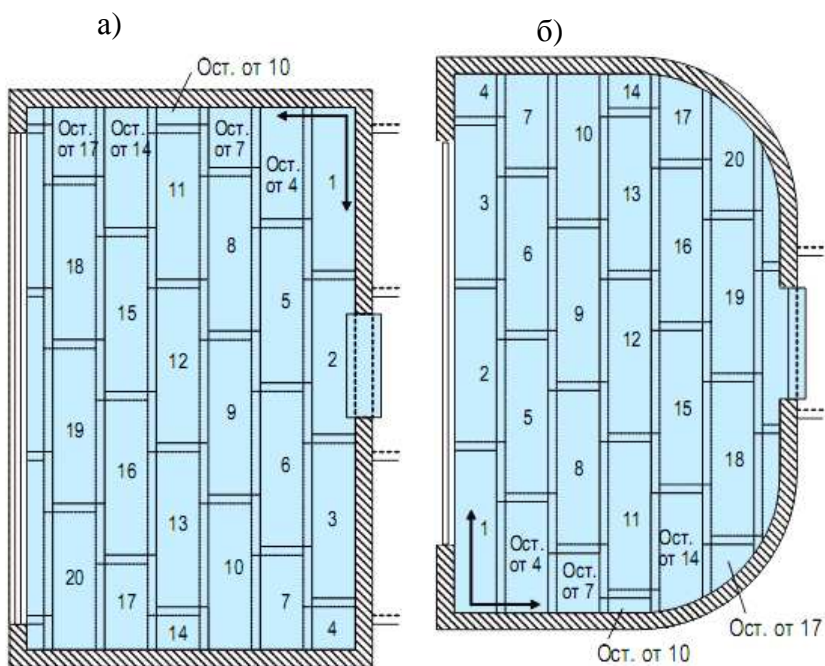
Схемы раскладки элементов пола при укладке в направлении от стены с дверным проемом (а) и от стены, противоположной дверному проему (б)
